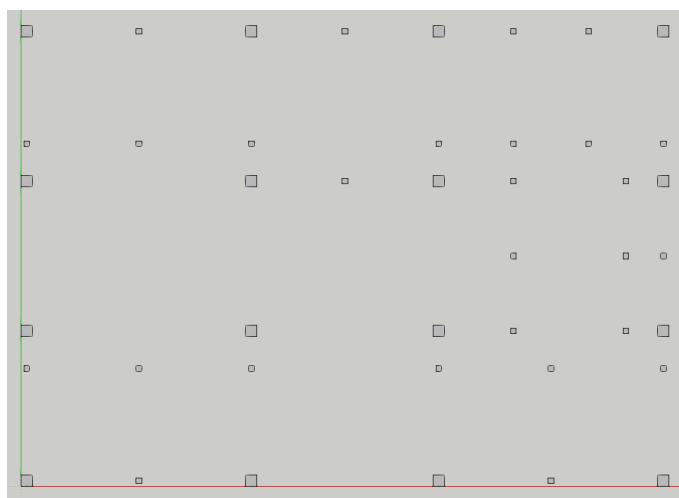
16 denah Lt 1 bangunan kampus Stital.
